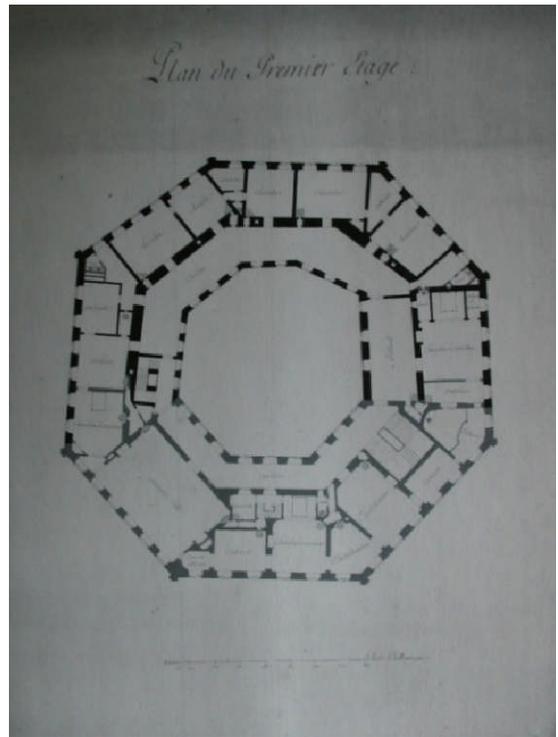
Grundriss erstes Obergeschoss von Cuvillies
